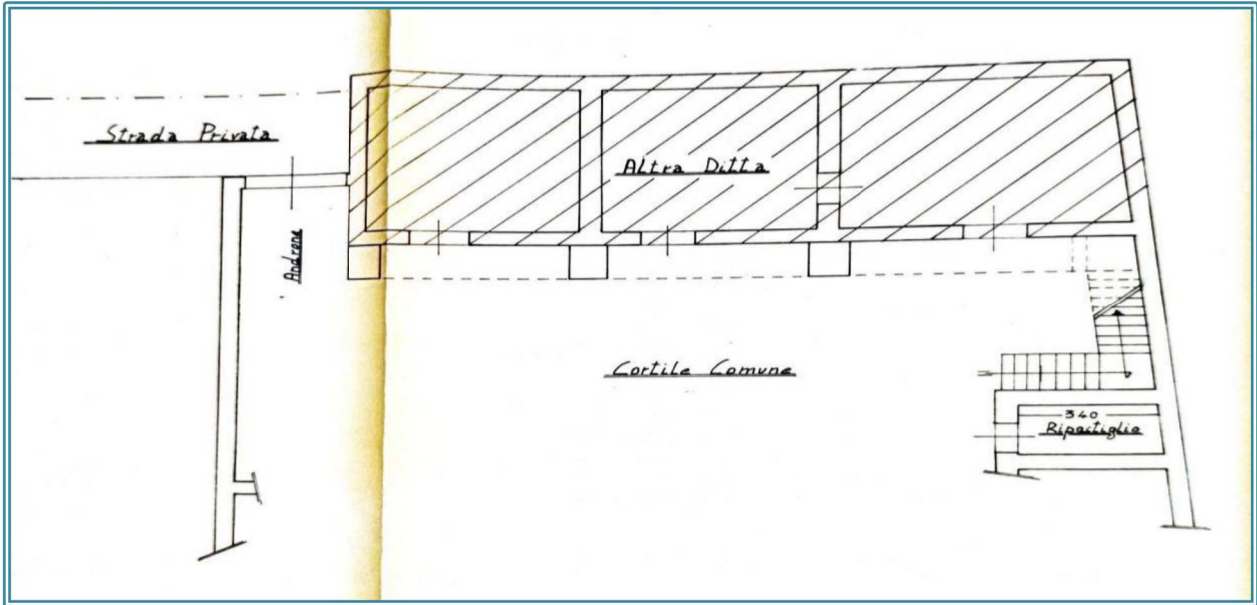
Pianta piano terra – estratto dal fascicolo pratica di costruzione edile n. 5951 del 17.03.1988
